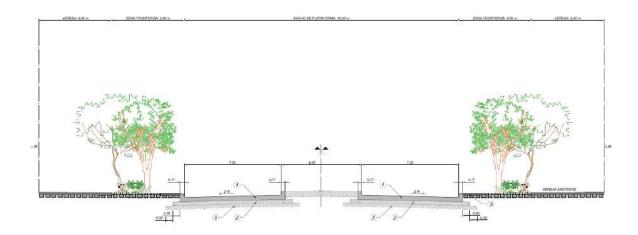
Perfil tipo Fuente: Estudio de Ingeniería
